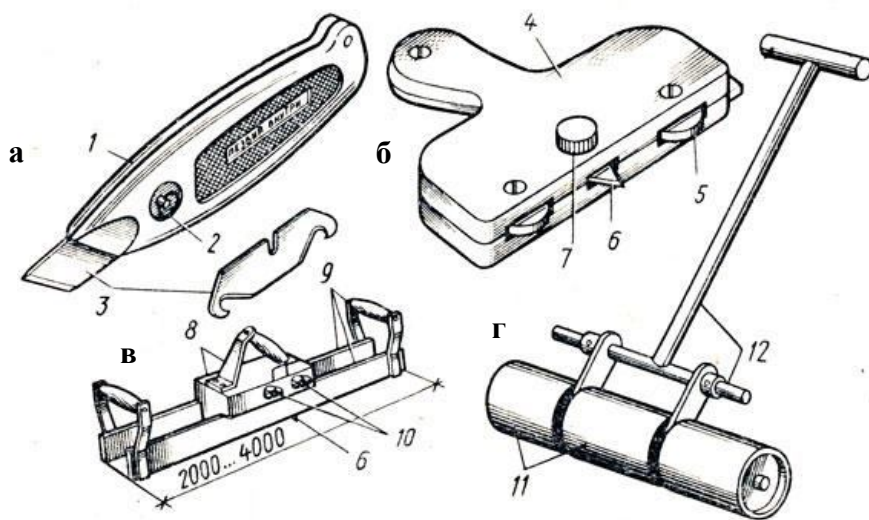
Інструменти для влаштування підлог з лінолеуму: а – ніж зі змінними лезами; б – спеціальний ніж, в – пристосування для прирізування крайків полотнищ; г – ручний коток; 1, 4 – корпуси; 2 – затискний гвинт; 3 – змінні леза; 5 – підшипник; 6 – ніж; 7 – гвинт; 8 – корпус із держакком; 9 – напрямна з держакками; 10 – притискні гвинти; 11 – чавунні валки; 12 – рама з ручкою
